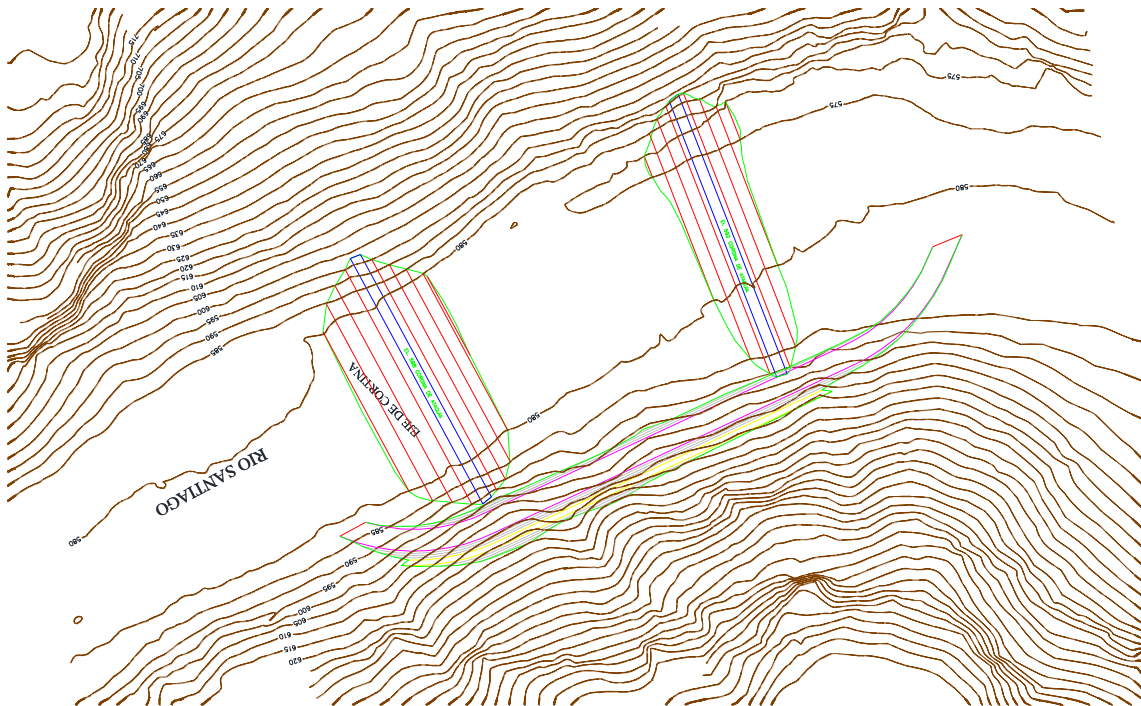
Vista en planta del arreglo de las obras para el desvío
